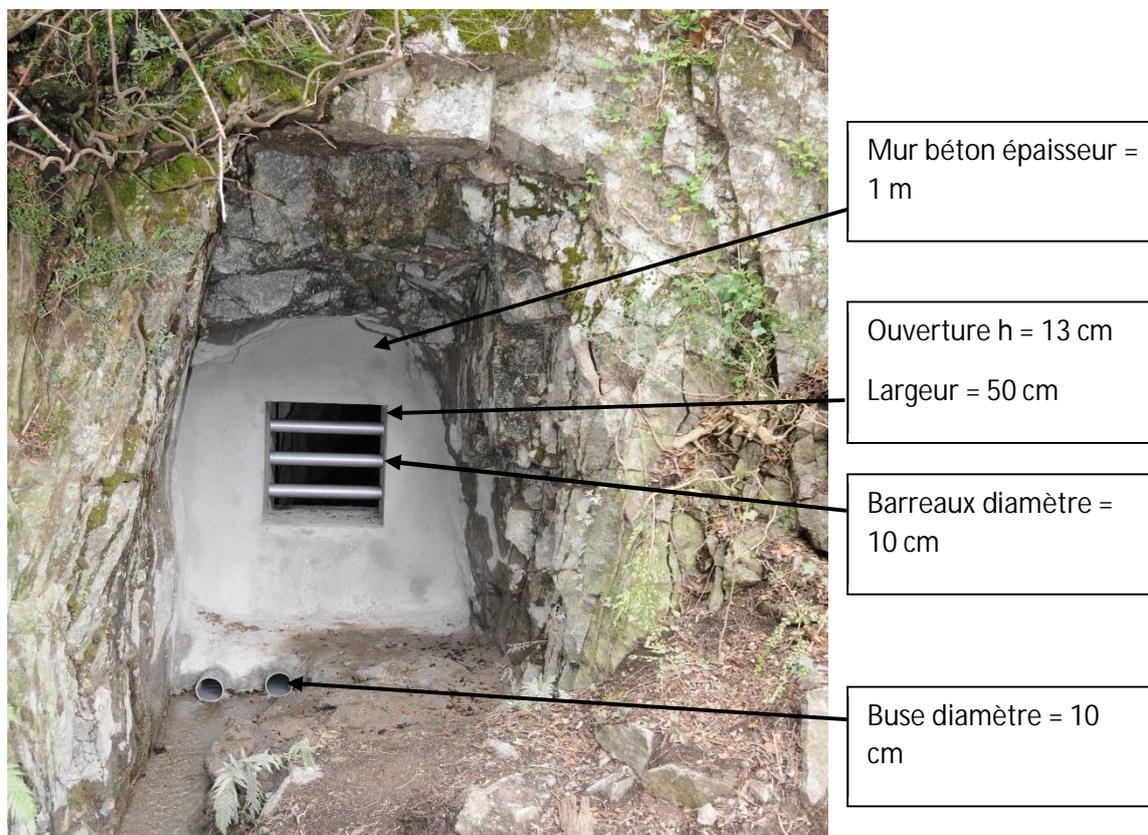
Exemple de galerie condamnée par un mur en béton, avec passage chiroptère et passage faune rampante aménagé.
